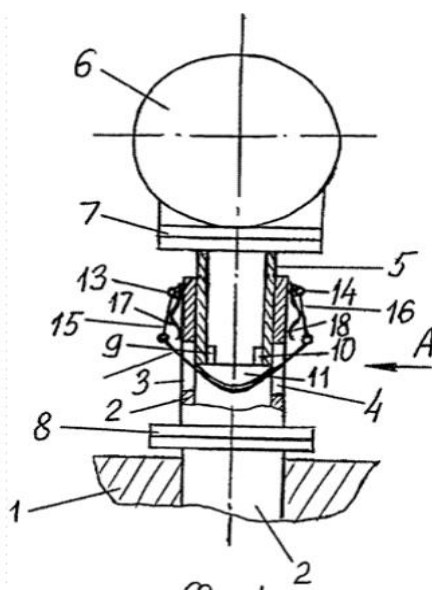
Схема опоры с пружинами: 1 - грунт; 2- полое основание; 3 и 4 - продольные пазы; 5 - стойка; 6 - трубопровод; 2 - полость основания; 7 и 8 - опорно-поворотные узлы, 9 и 10 - кронштейны 11- дугообразный элемент; 12 - гибкий элемент; 13 и 14 - шарниры 15 и 16 - рычаги; 17 и 18 – пружины
